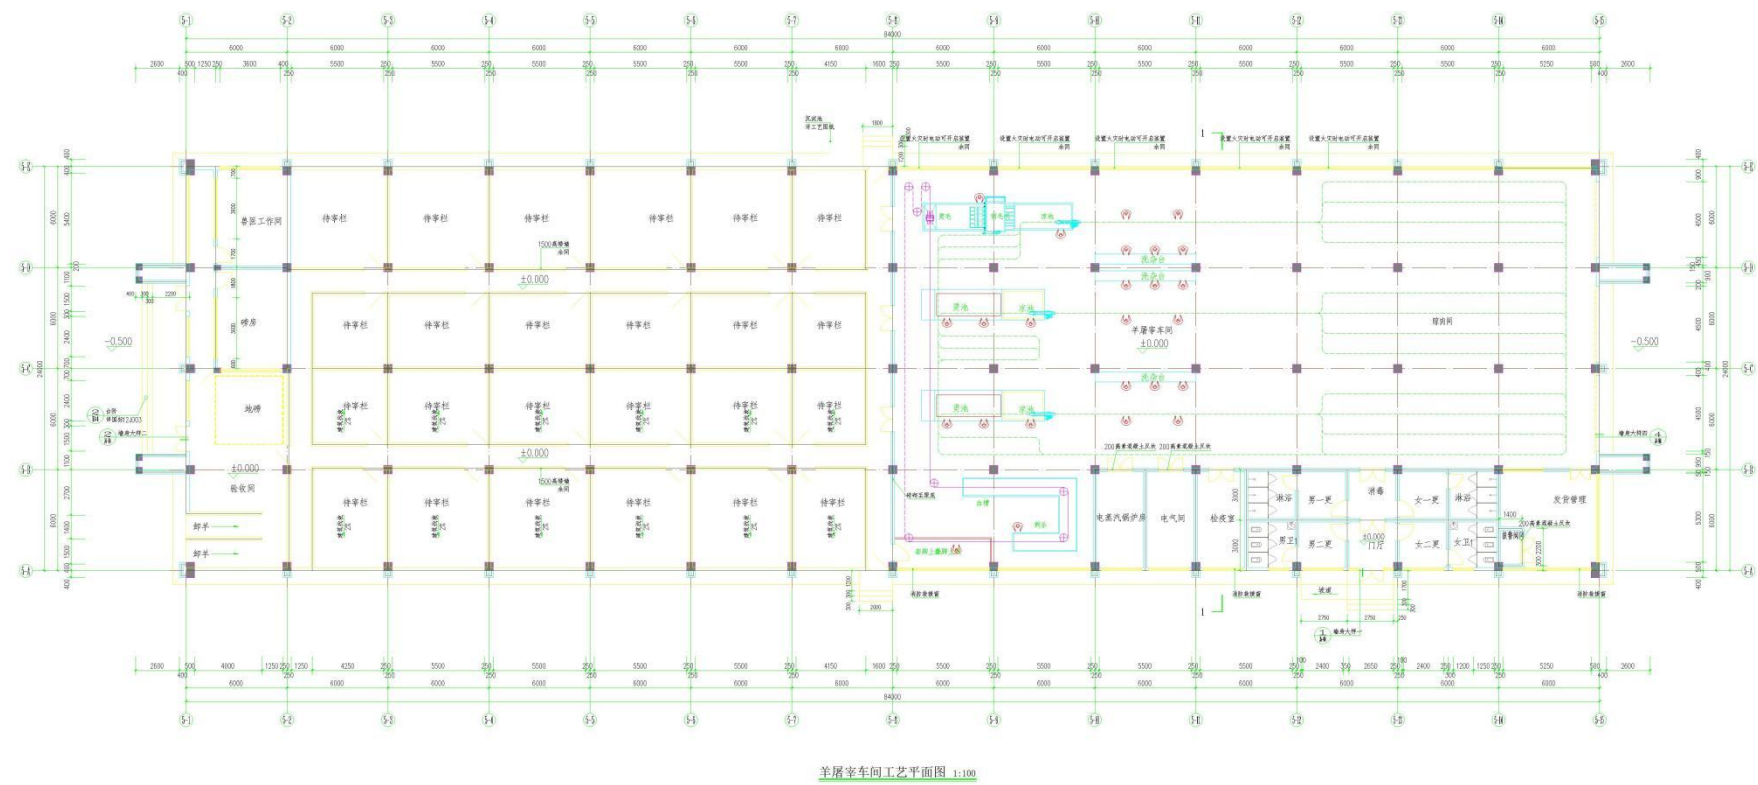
肉羊待宰间及屠宰车间平面布置图
